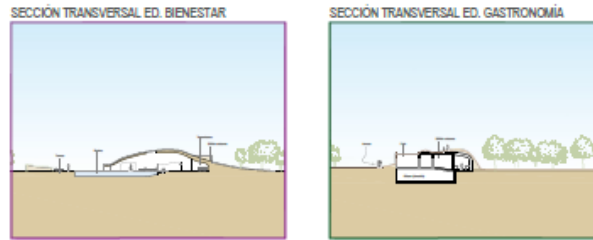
Alzados de edificios colina bienestar y gastronómico (Sección transversal).
